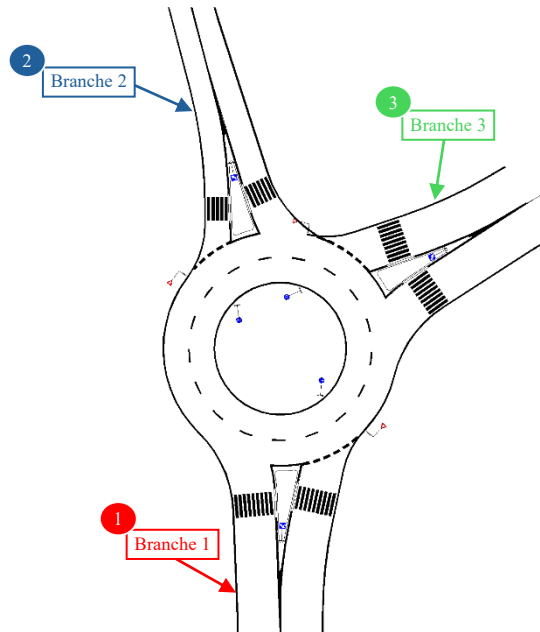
Vue en plan sur le troisième carrefour
